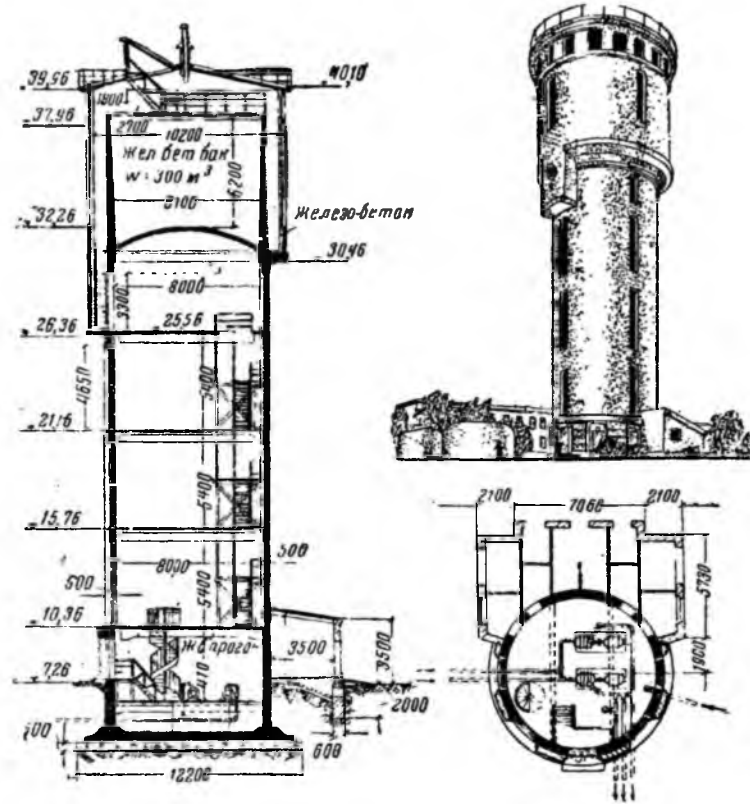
Водонапорная башня со сплошным железобетонным стволом
